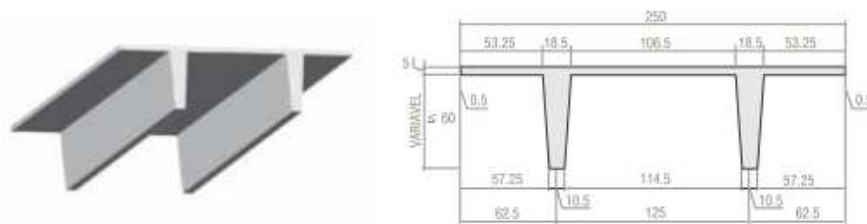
Dimensões da laje pi fabricada pela Cassol
